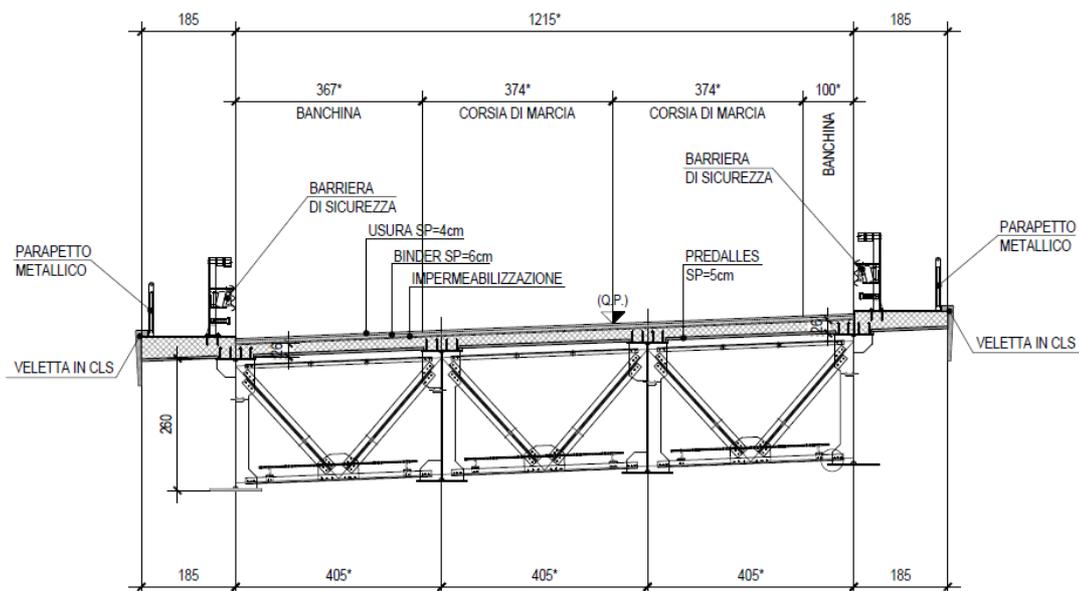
Sezione tipo NW02 con impalcato in cap da 49 m
